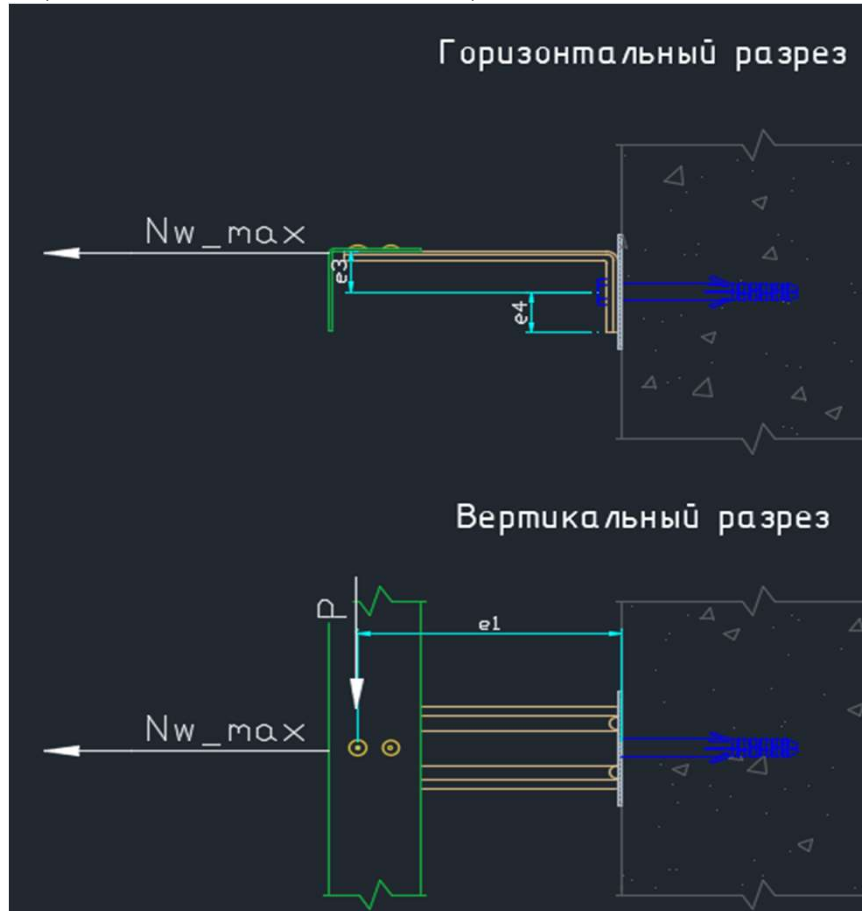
Расчетная схема проверки анкерного элемента на вырыв
